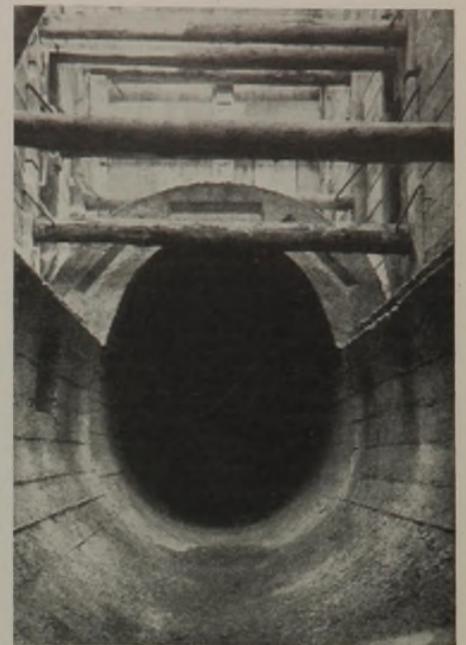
Fertiger Betonkörper des Kanals unter den Eisenbahnanlagen vor Einbringung der Stahlbetonsohle und des Innenputzes.
